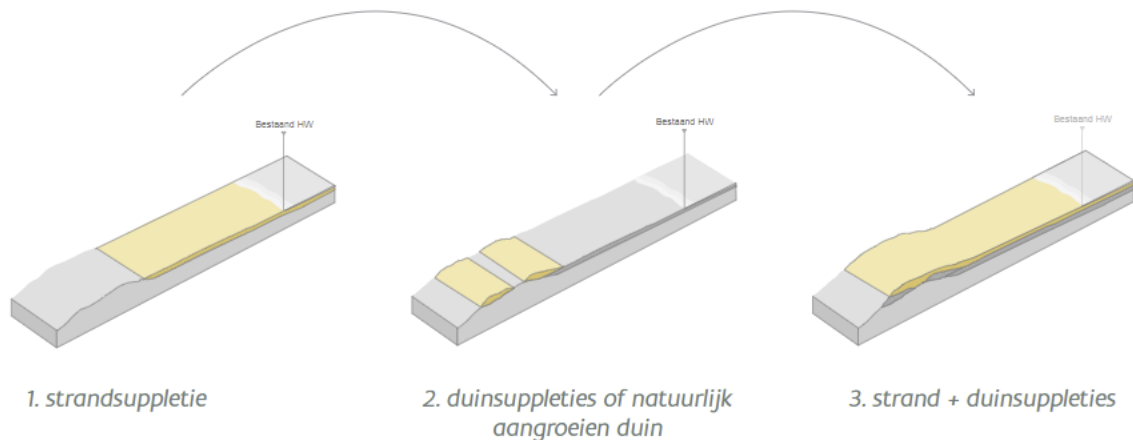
Principe stappenplan voor het redelijk alternatief “Ter plaatse” ter hoogte van de badsteden.
